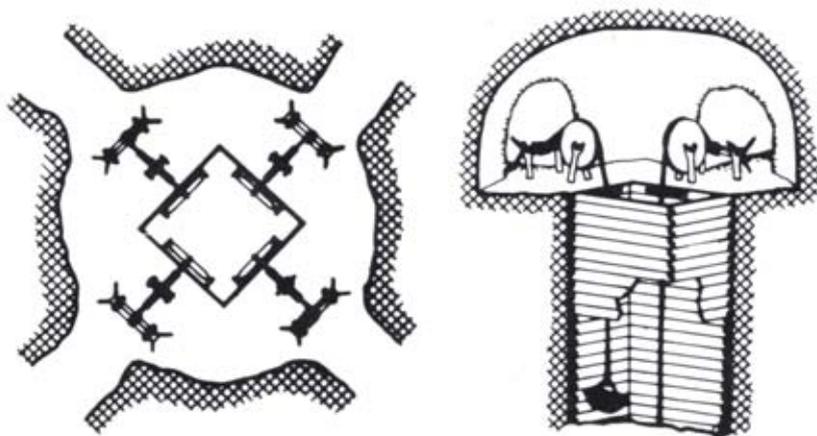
Planta y sección de un acceso a mina por pozo vertical con poleas para extraer el mineral (Según Antona y Gómez, 1987, 53)
